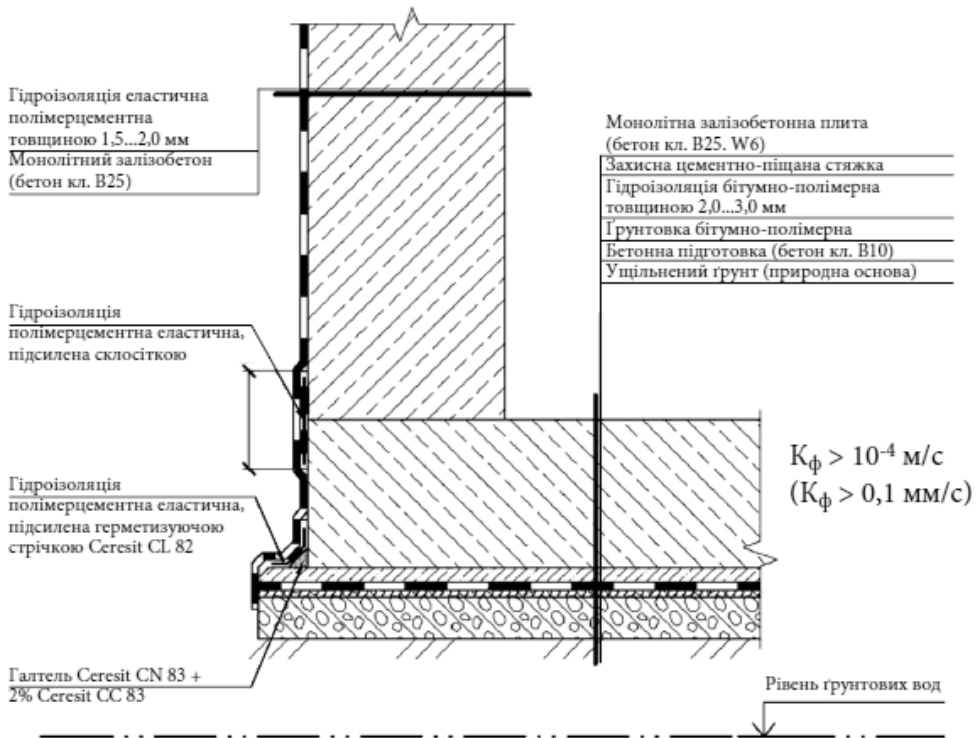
Гідроізоляція бетонних плит основи і стін підземних споруд в умовах впливу ґрунтової вологи.
